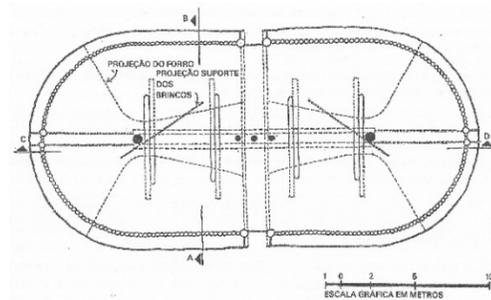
Estrutura da casa Yawalapiti: planta baixa (casa 4 na planta geral da aldeia).
